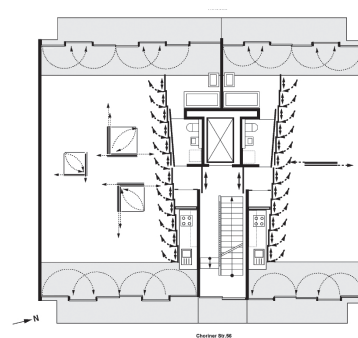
, 13, 14: Berlin Choriner Straße, Architekt Wolfram Popp
